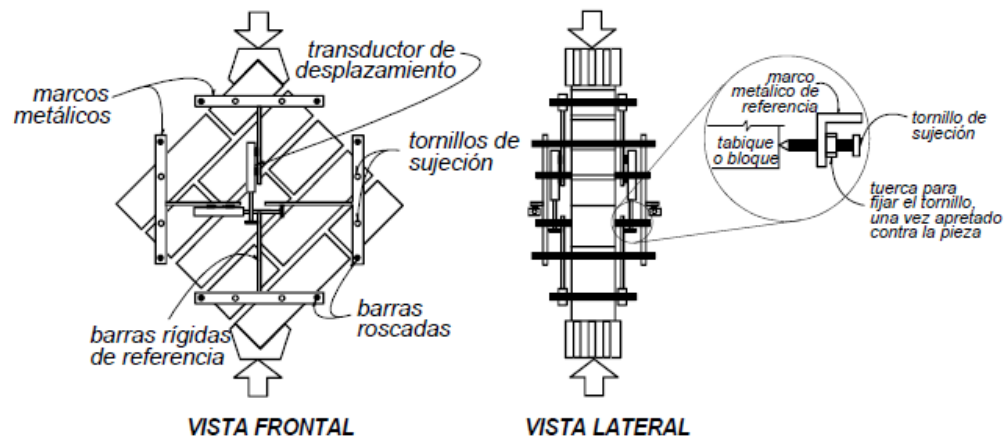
Prisma y montaje de instrumentos para ensayo de compresión diagonal
